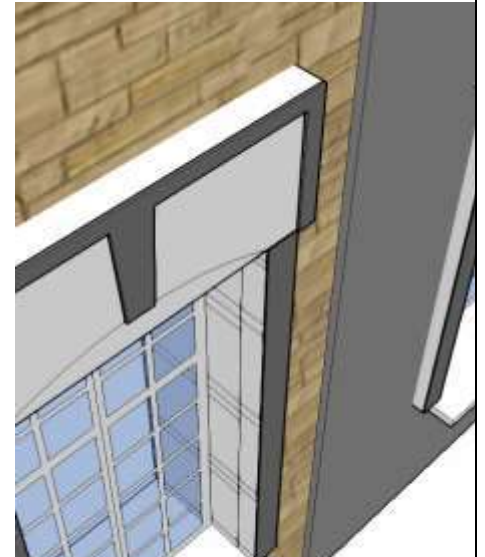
Différence de niveau de façade de 5cm induit par le chemisage.
